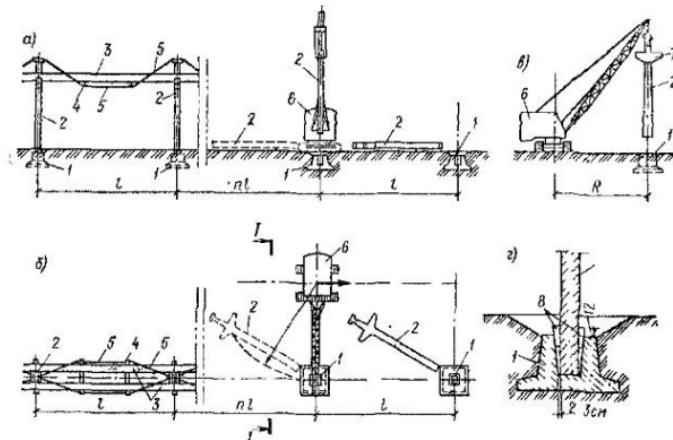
Монтаж железобетонных мачт для надземной прокладки теплопроводов
